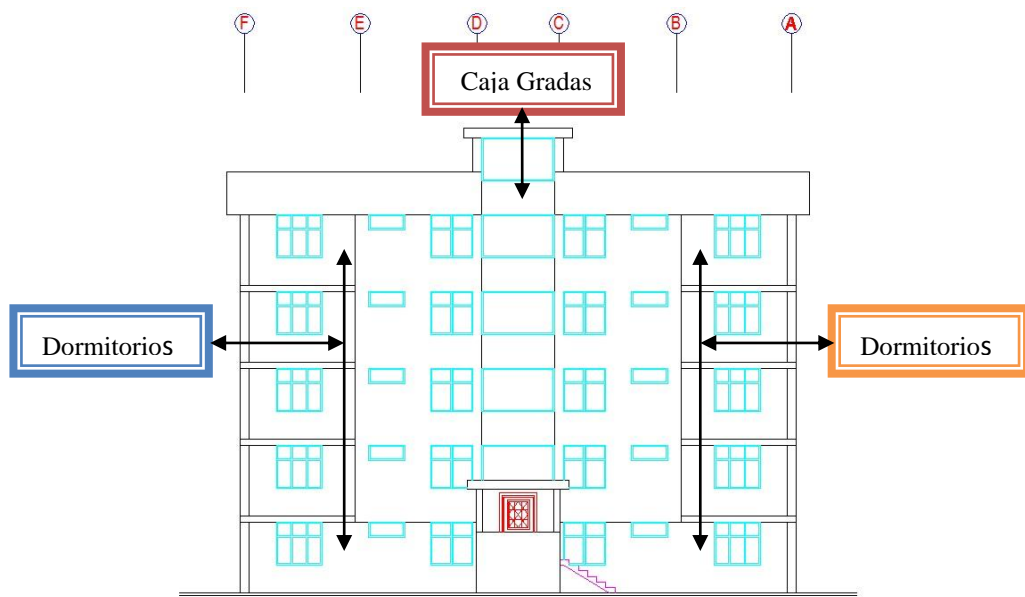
Levantamiento Arquitectónico Salon Comunal - Departamento
